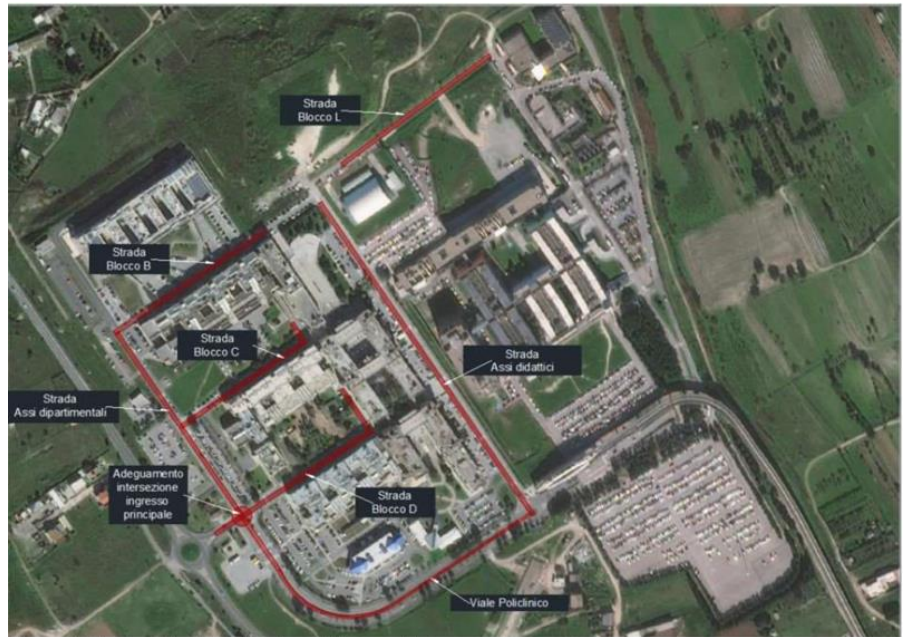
Planimetria di Individuazione delle aree di intervento in progetto
